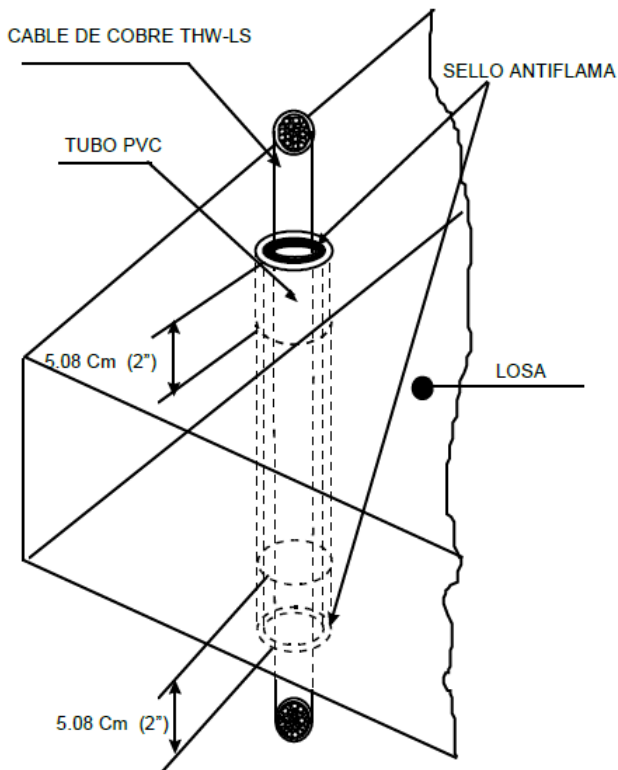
Paso de Cable por Losa Mediante Tubo Conduit de PVC.
